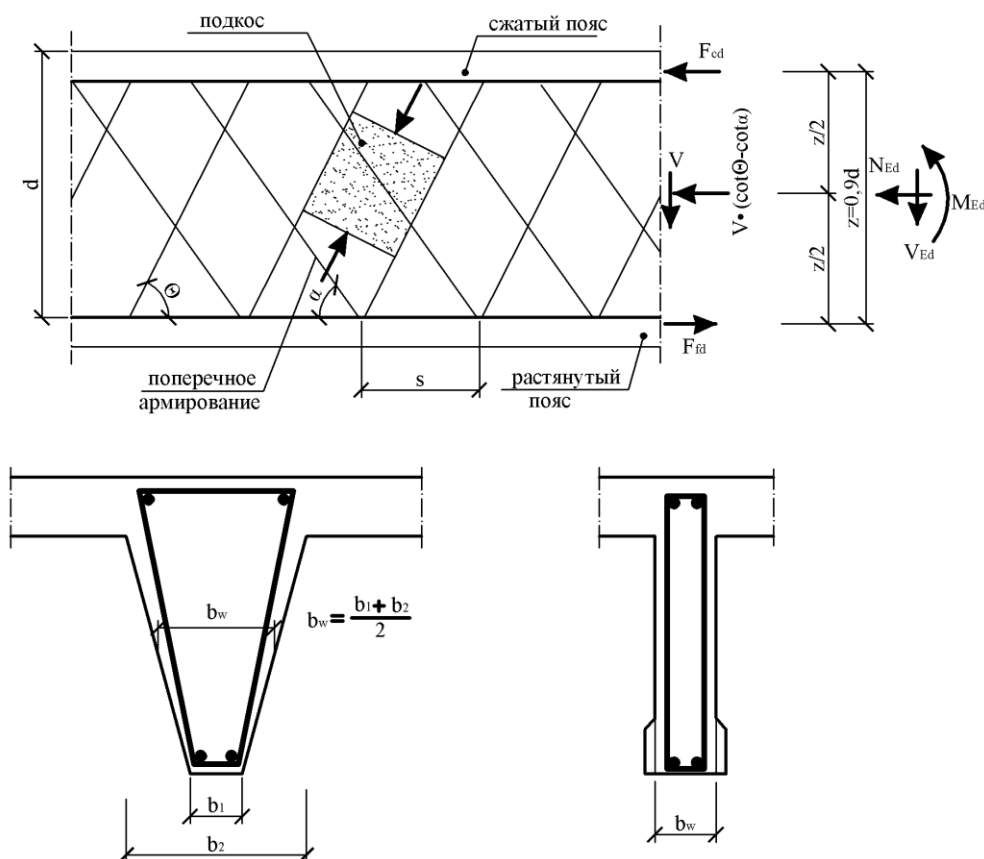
К расчету прочности железобетонных элементов при действии поперечной силы на основе стержневой модели
